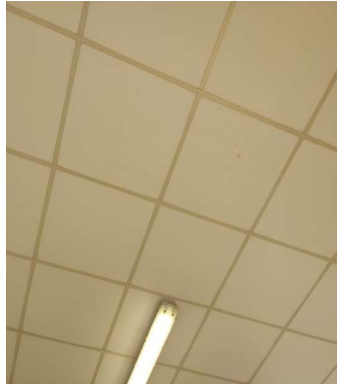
Teto da Planta Piloto de Produtos Cárneos e Base Lipídica
